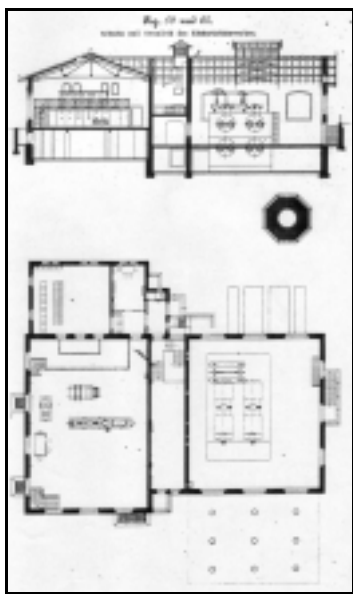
Schnitt (oben) und Grundriss (unten) des Fernheiz- und Elektrizitätswerk [10]
